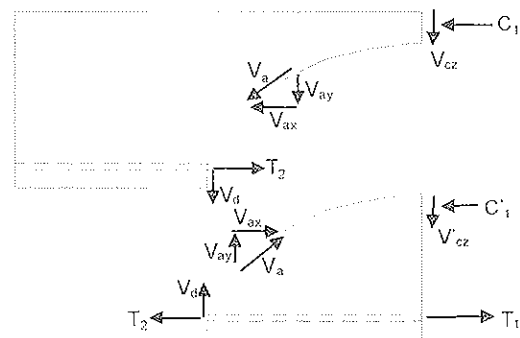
Fuerzas internas en una viga de hormigón fisurada sin armadura a cortante (adaptado de MacGregor y Bartlett 2000).
